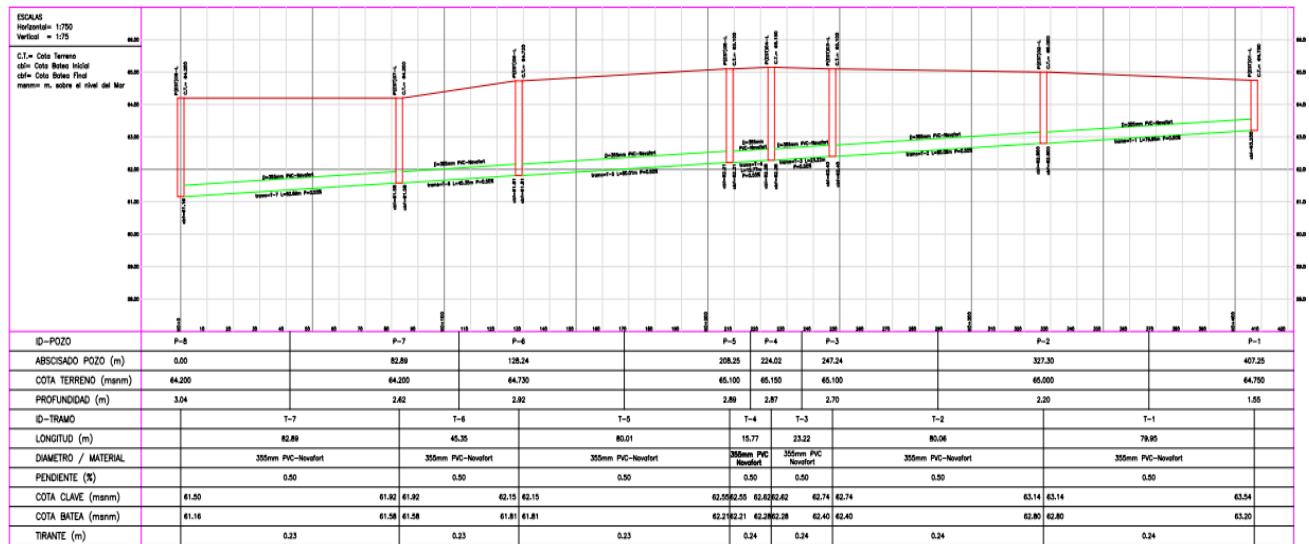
perfil alcantarillado pluvial remodelación estadio Puerto Wilches
